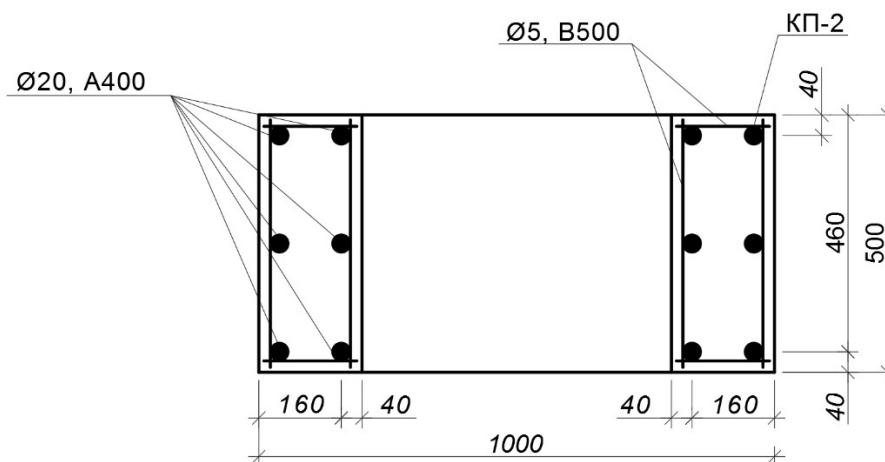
Схема армирования сечения подкрановой части колонны (2-1)
